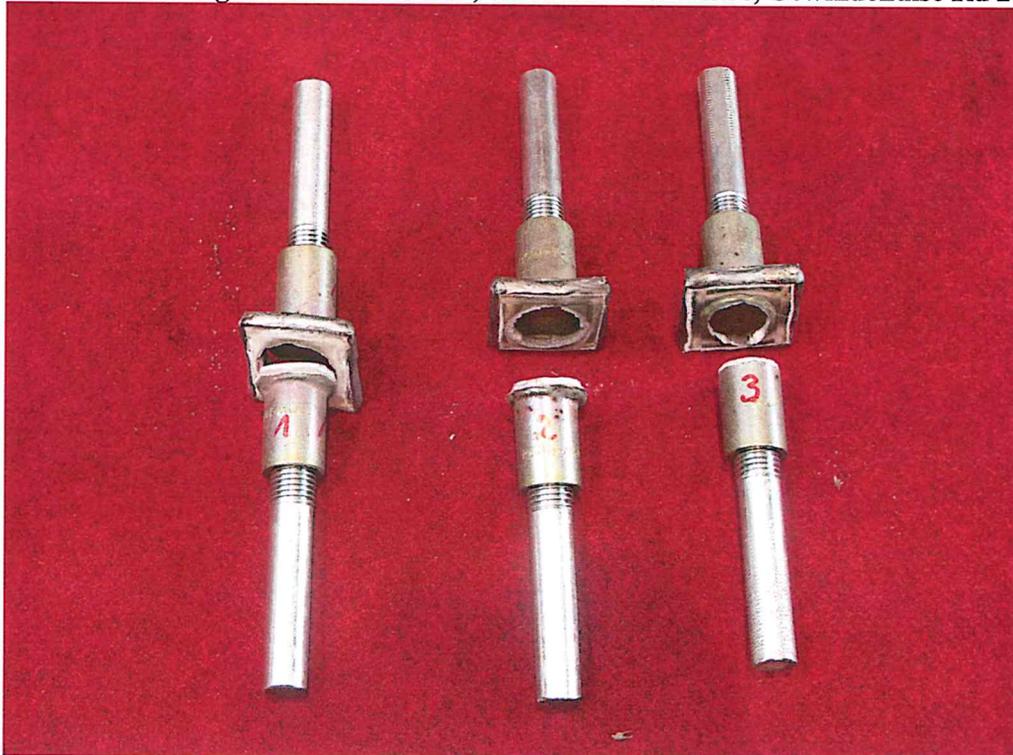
Bruchlagen Flachstahlanker, Durchmesser 38, Gewindehülse Rd 30 ; 4t
